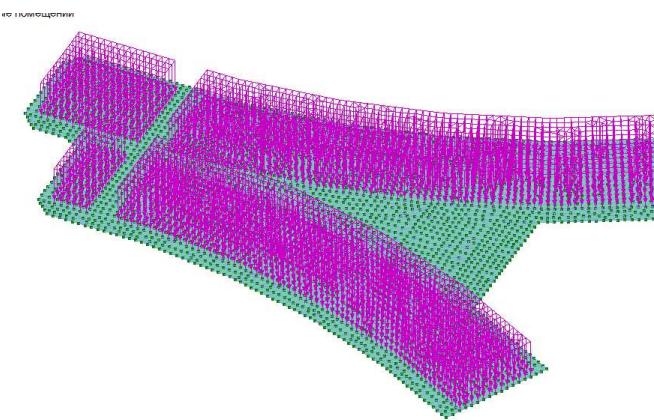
Нагрузка в жилых помещениях, 2-27 этажи
